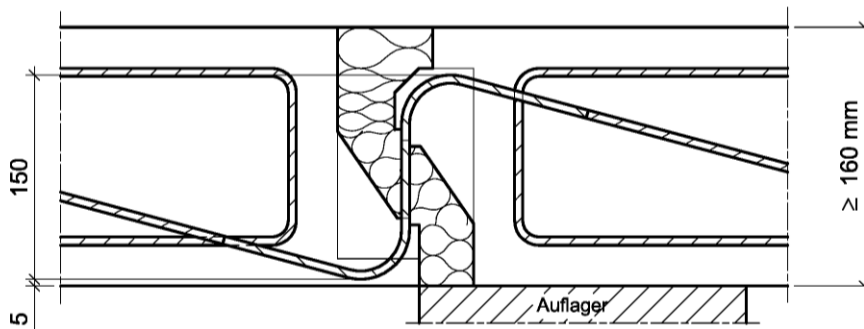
Beispiel Schöck Isokorb® Typ V mit Vertikalbewehrung nach Abschn. 3.1.5
